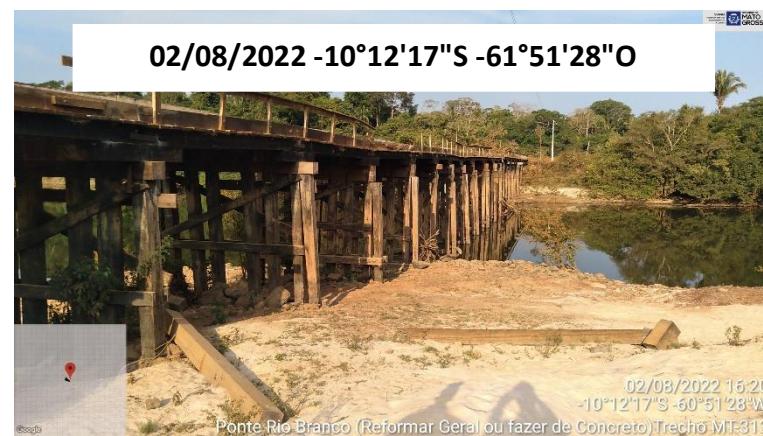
VISTA PONTE DE MADEIRA SOBRE O RIO BRANCO
